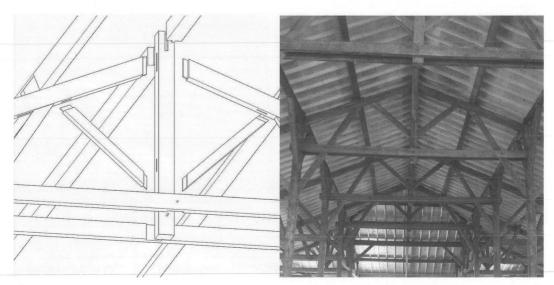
Nudo central en un estado previo a la restauración y estado actual (dibujo y foto del autor 2011)
